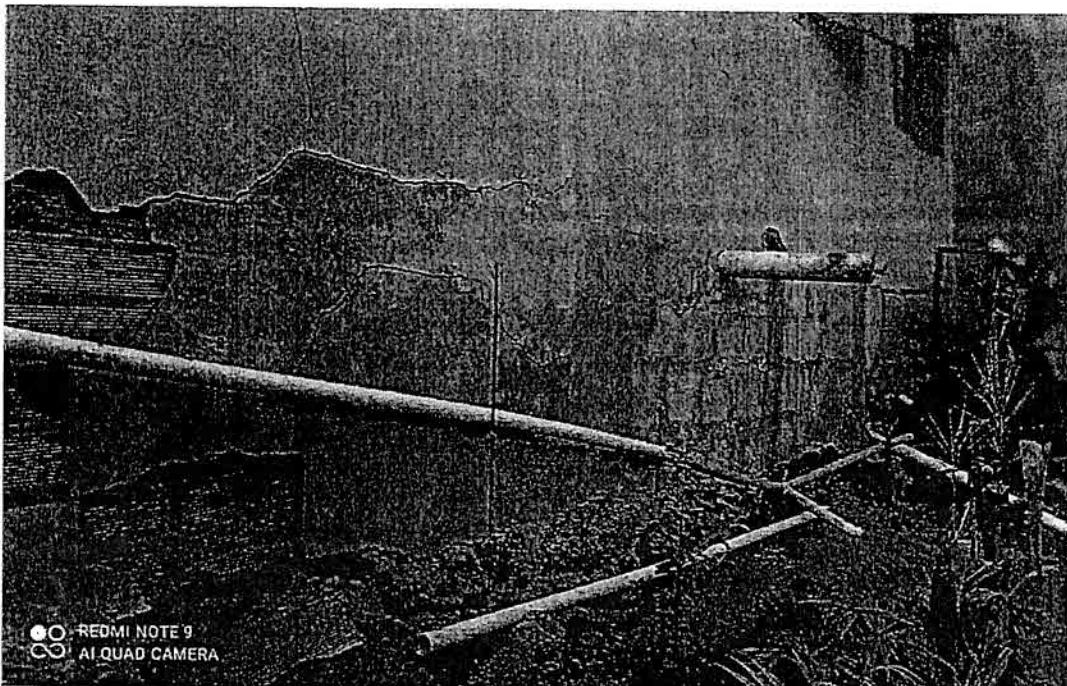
Parede construída sobre o aterro com fundação superficial.
